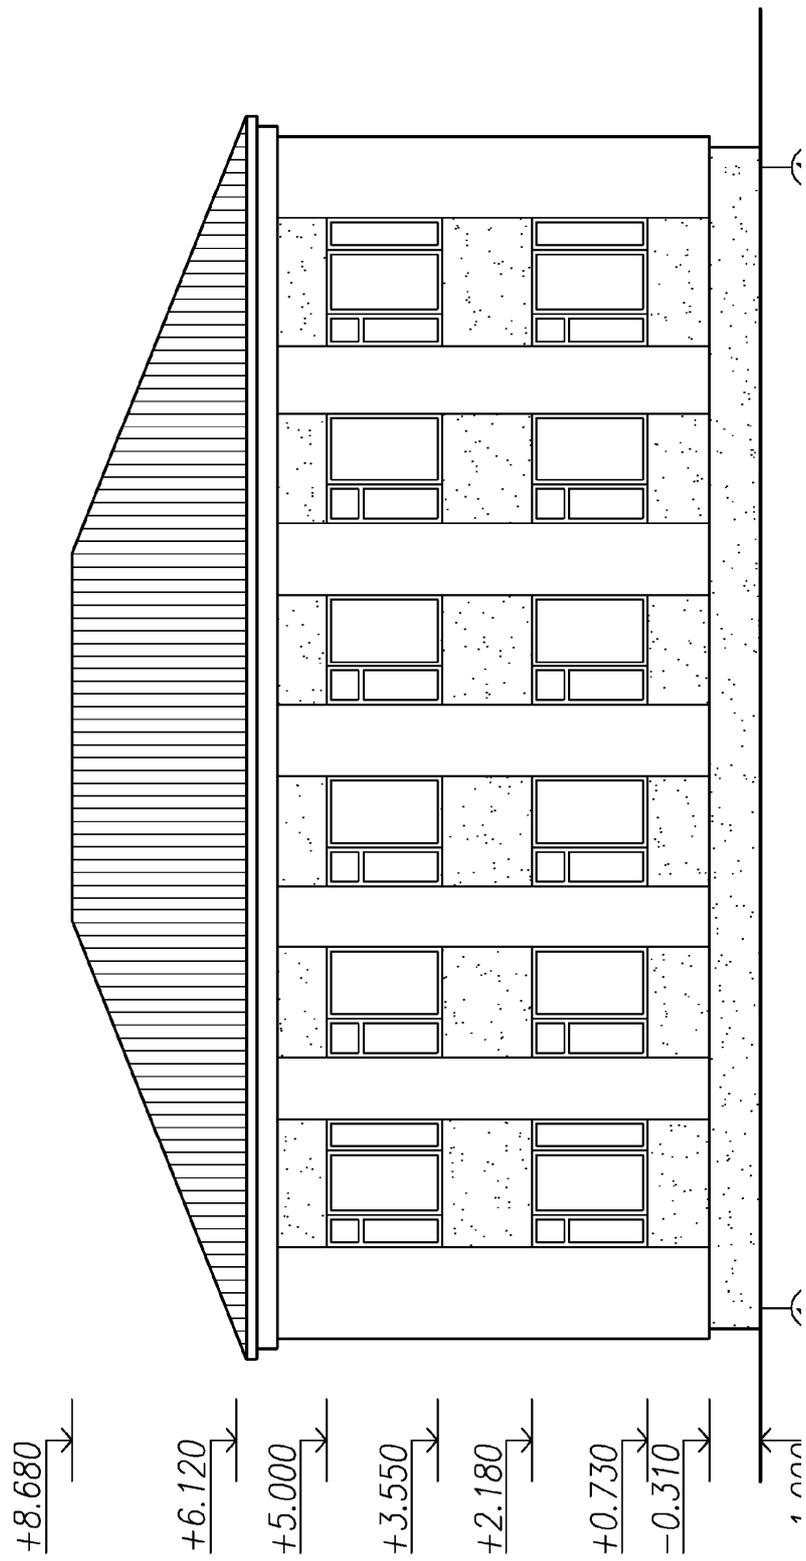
Пример решения фасада двухэтажного кирпичного жилого дома со скатной кровлей
